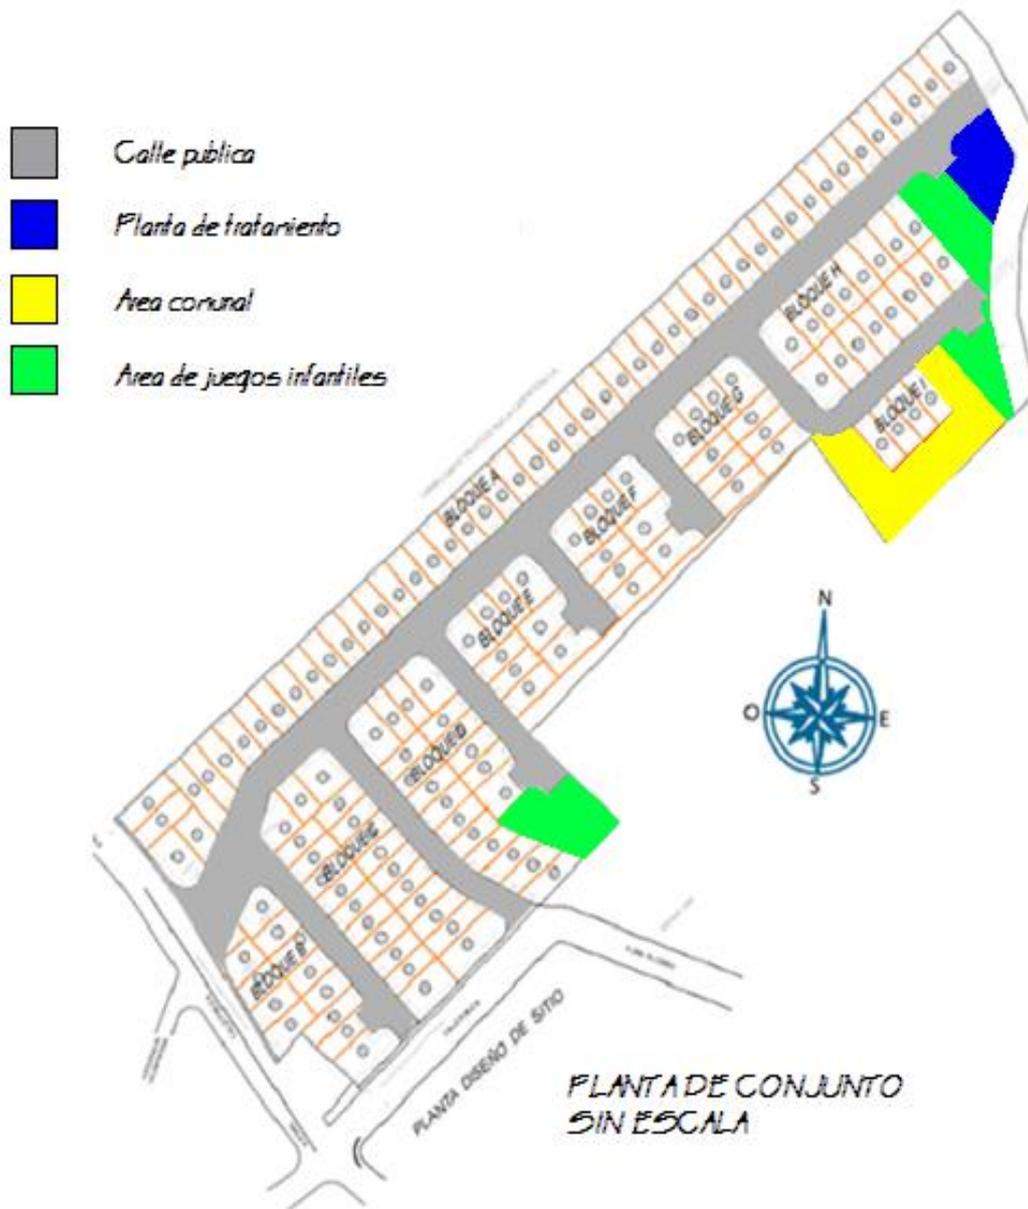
Planta de conjunto del residencial Los Geranios, con ubicación de propiedades, áreas comunes y planta de tratamiento.
